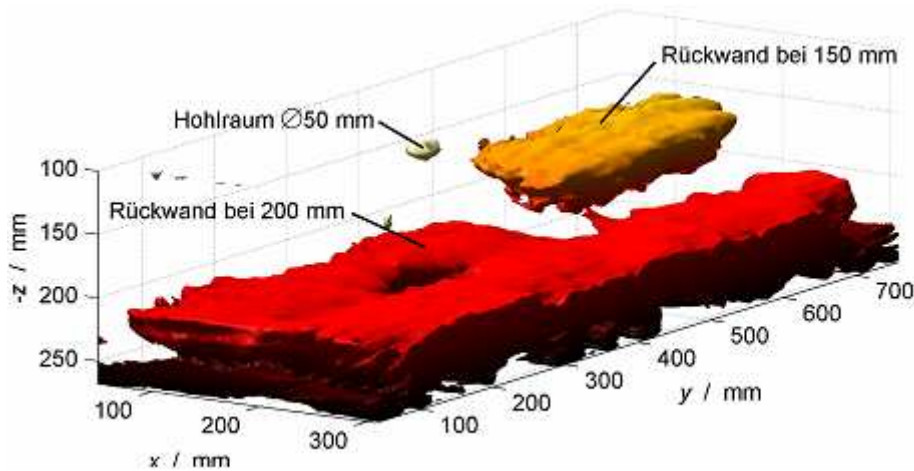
3D-Darstellung eines Betontestkörpers mit einem Rückwandversatz sowie einem Hohlraum mit 50 mmØ [13]
